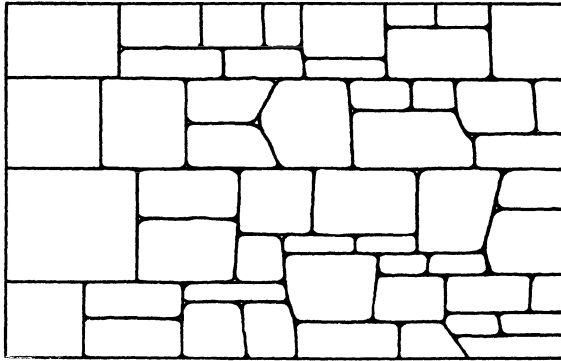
Mauerwerk aus lagerhaften Bruchsteinen.
